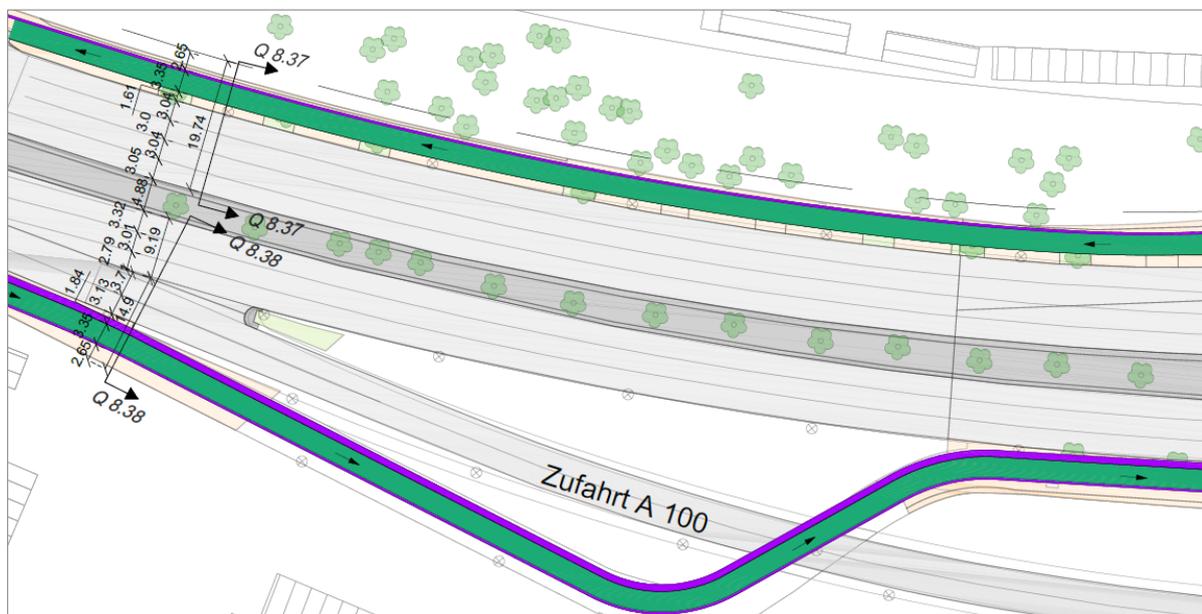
Siemensdamm/A 100 – Ausschnitt Lageplan
